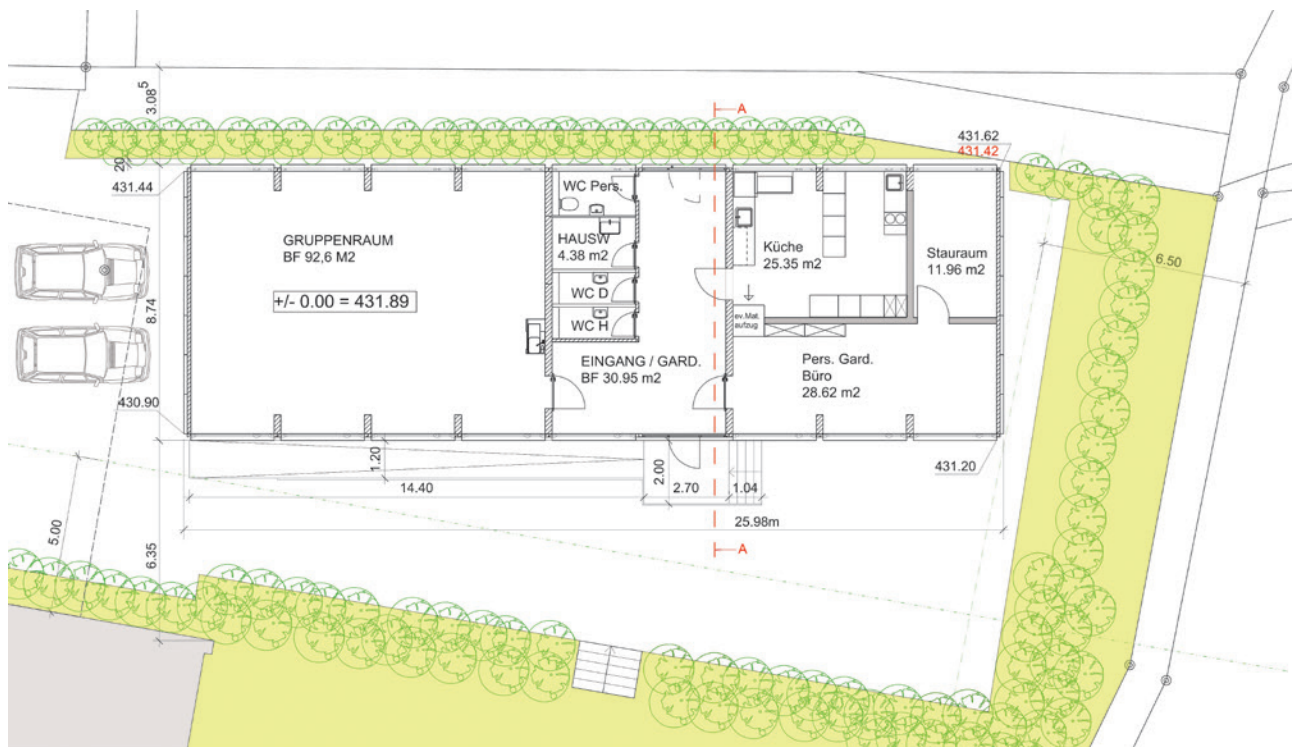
Grundriss Erdgeschoss mit umliegendem Aussenraum
